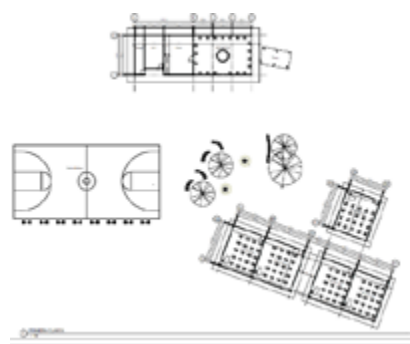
Levantamiento arquitectónico de la escuela (fuente: elaboración propia, 2022).
